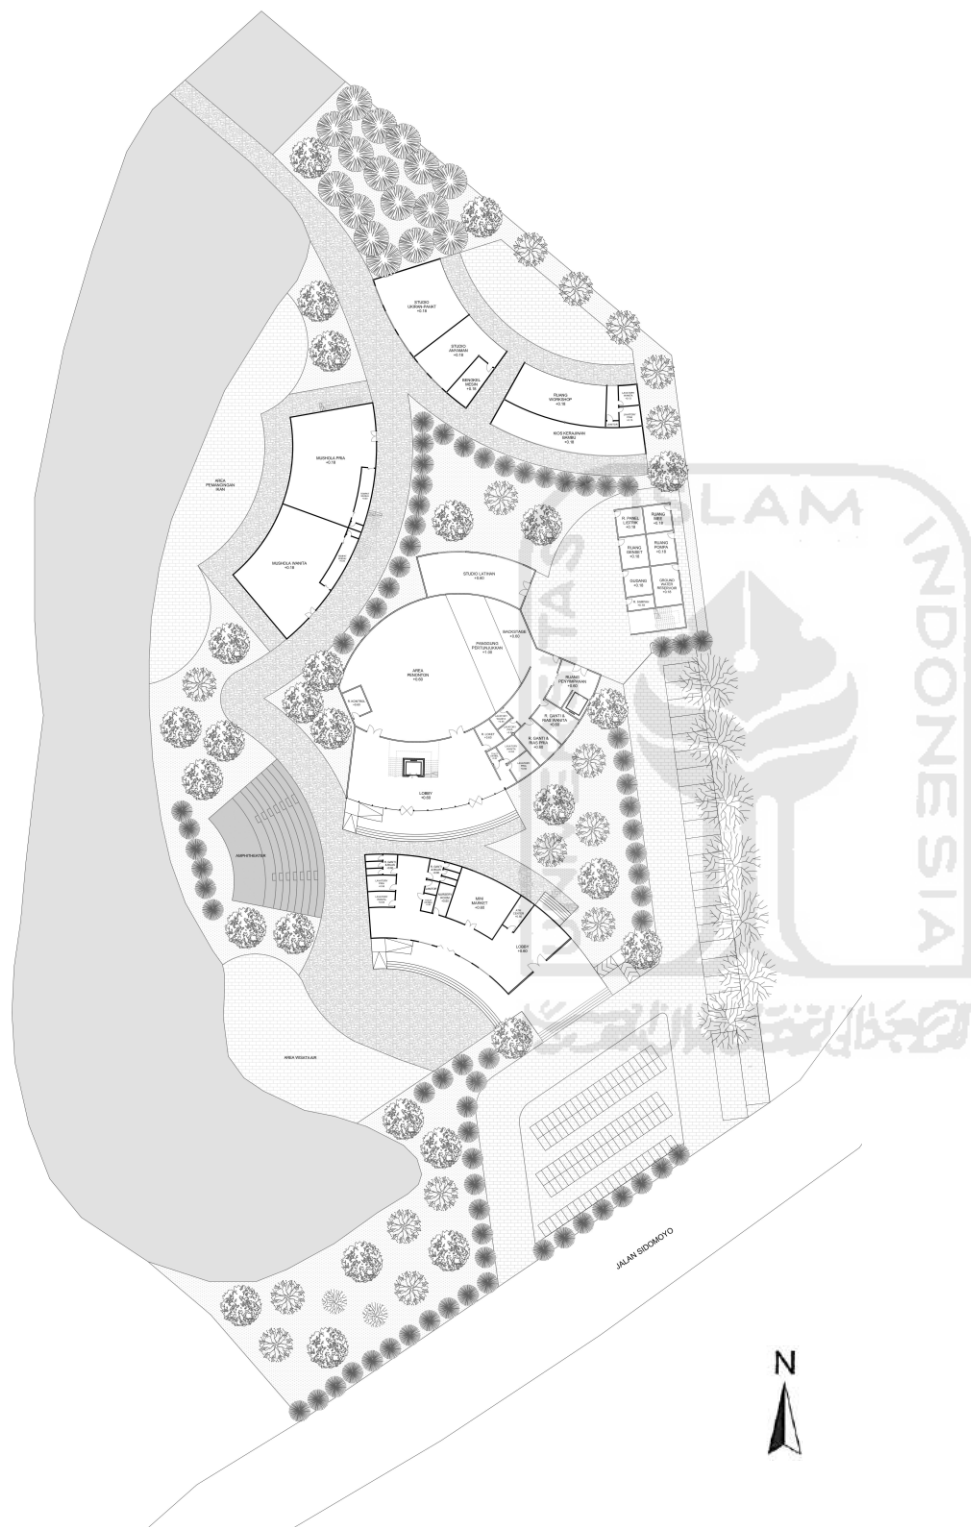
Gagasan Massa Bangunan Semi-outdoor
